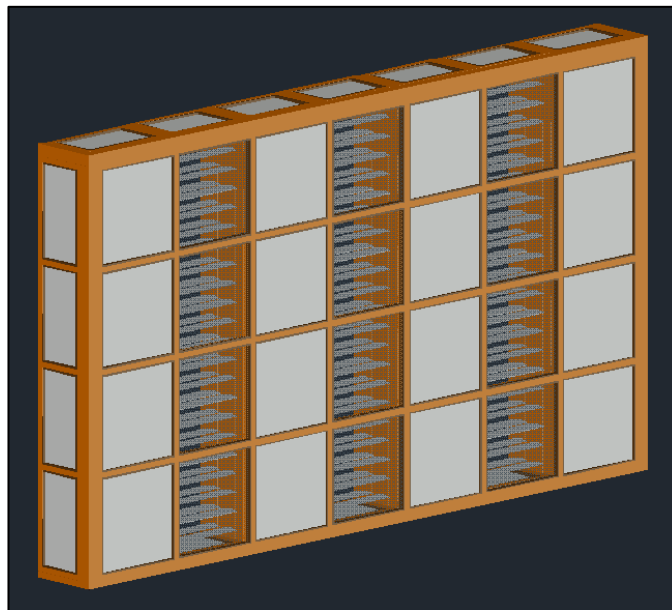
Representação da estrutura de madeira da fachada ventilada
